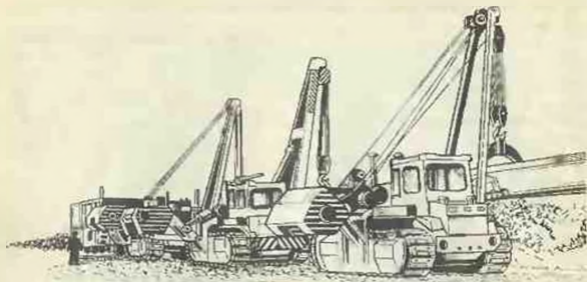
Колонна трубоукладчиков на строительстве магистрального газопровода
